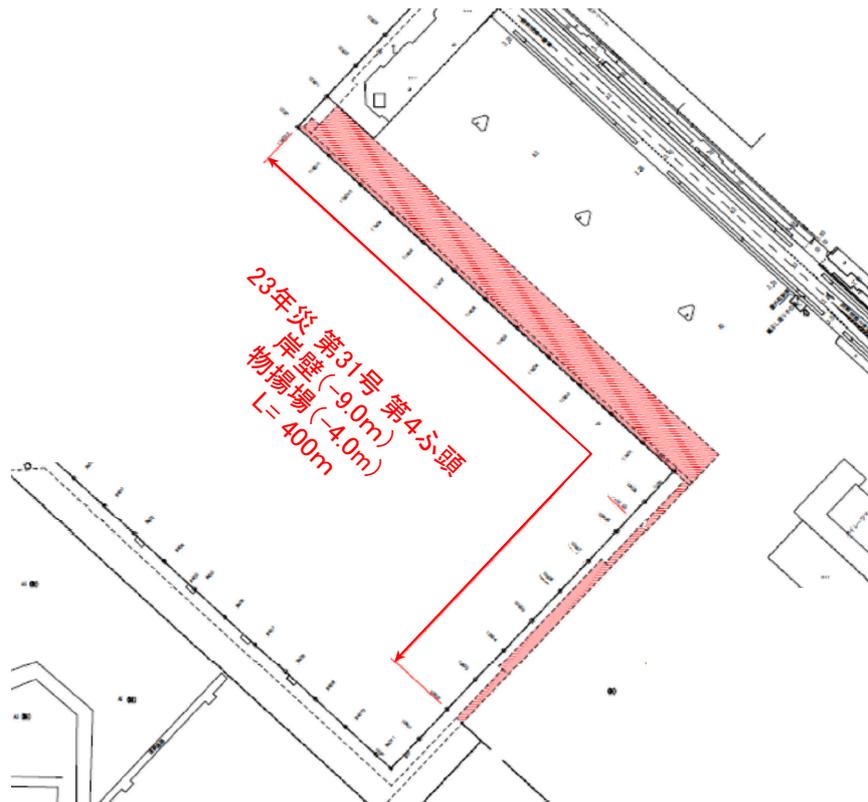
No.35 大洗港区_第4ふ頭地区岸壁(-9.0m)物揚場(-4.0m)の平面図(被災前)
